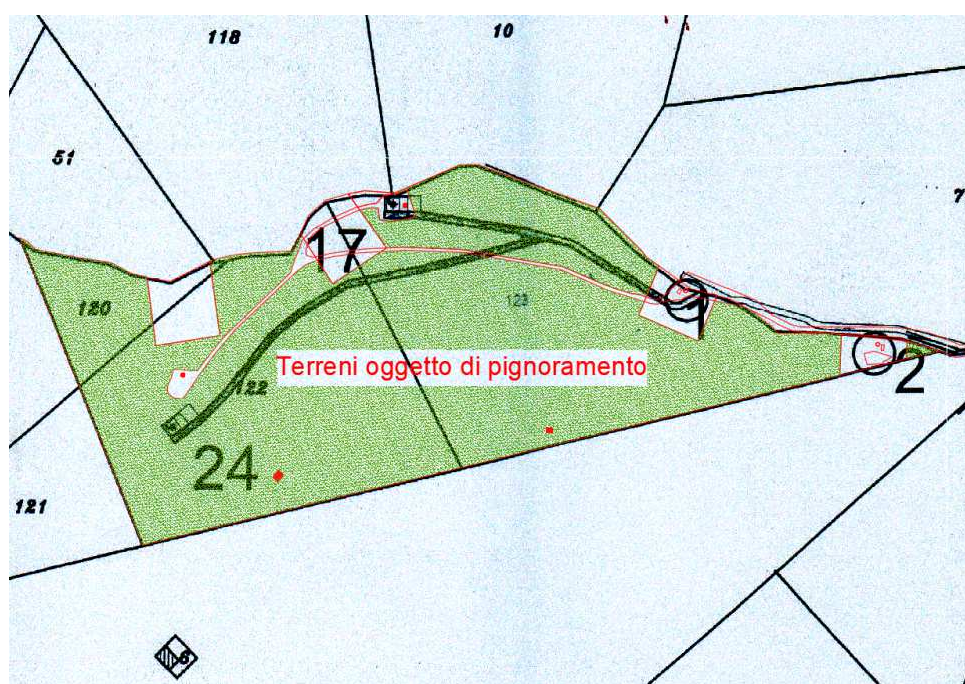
Sovrapposizione di planimetria di rilievo con stralcio di Allegato di progetto a corredo della Concessione Edilizia rilasciata il 21/11/2002
